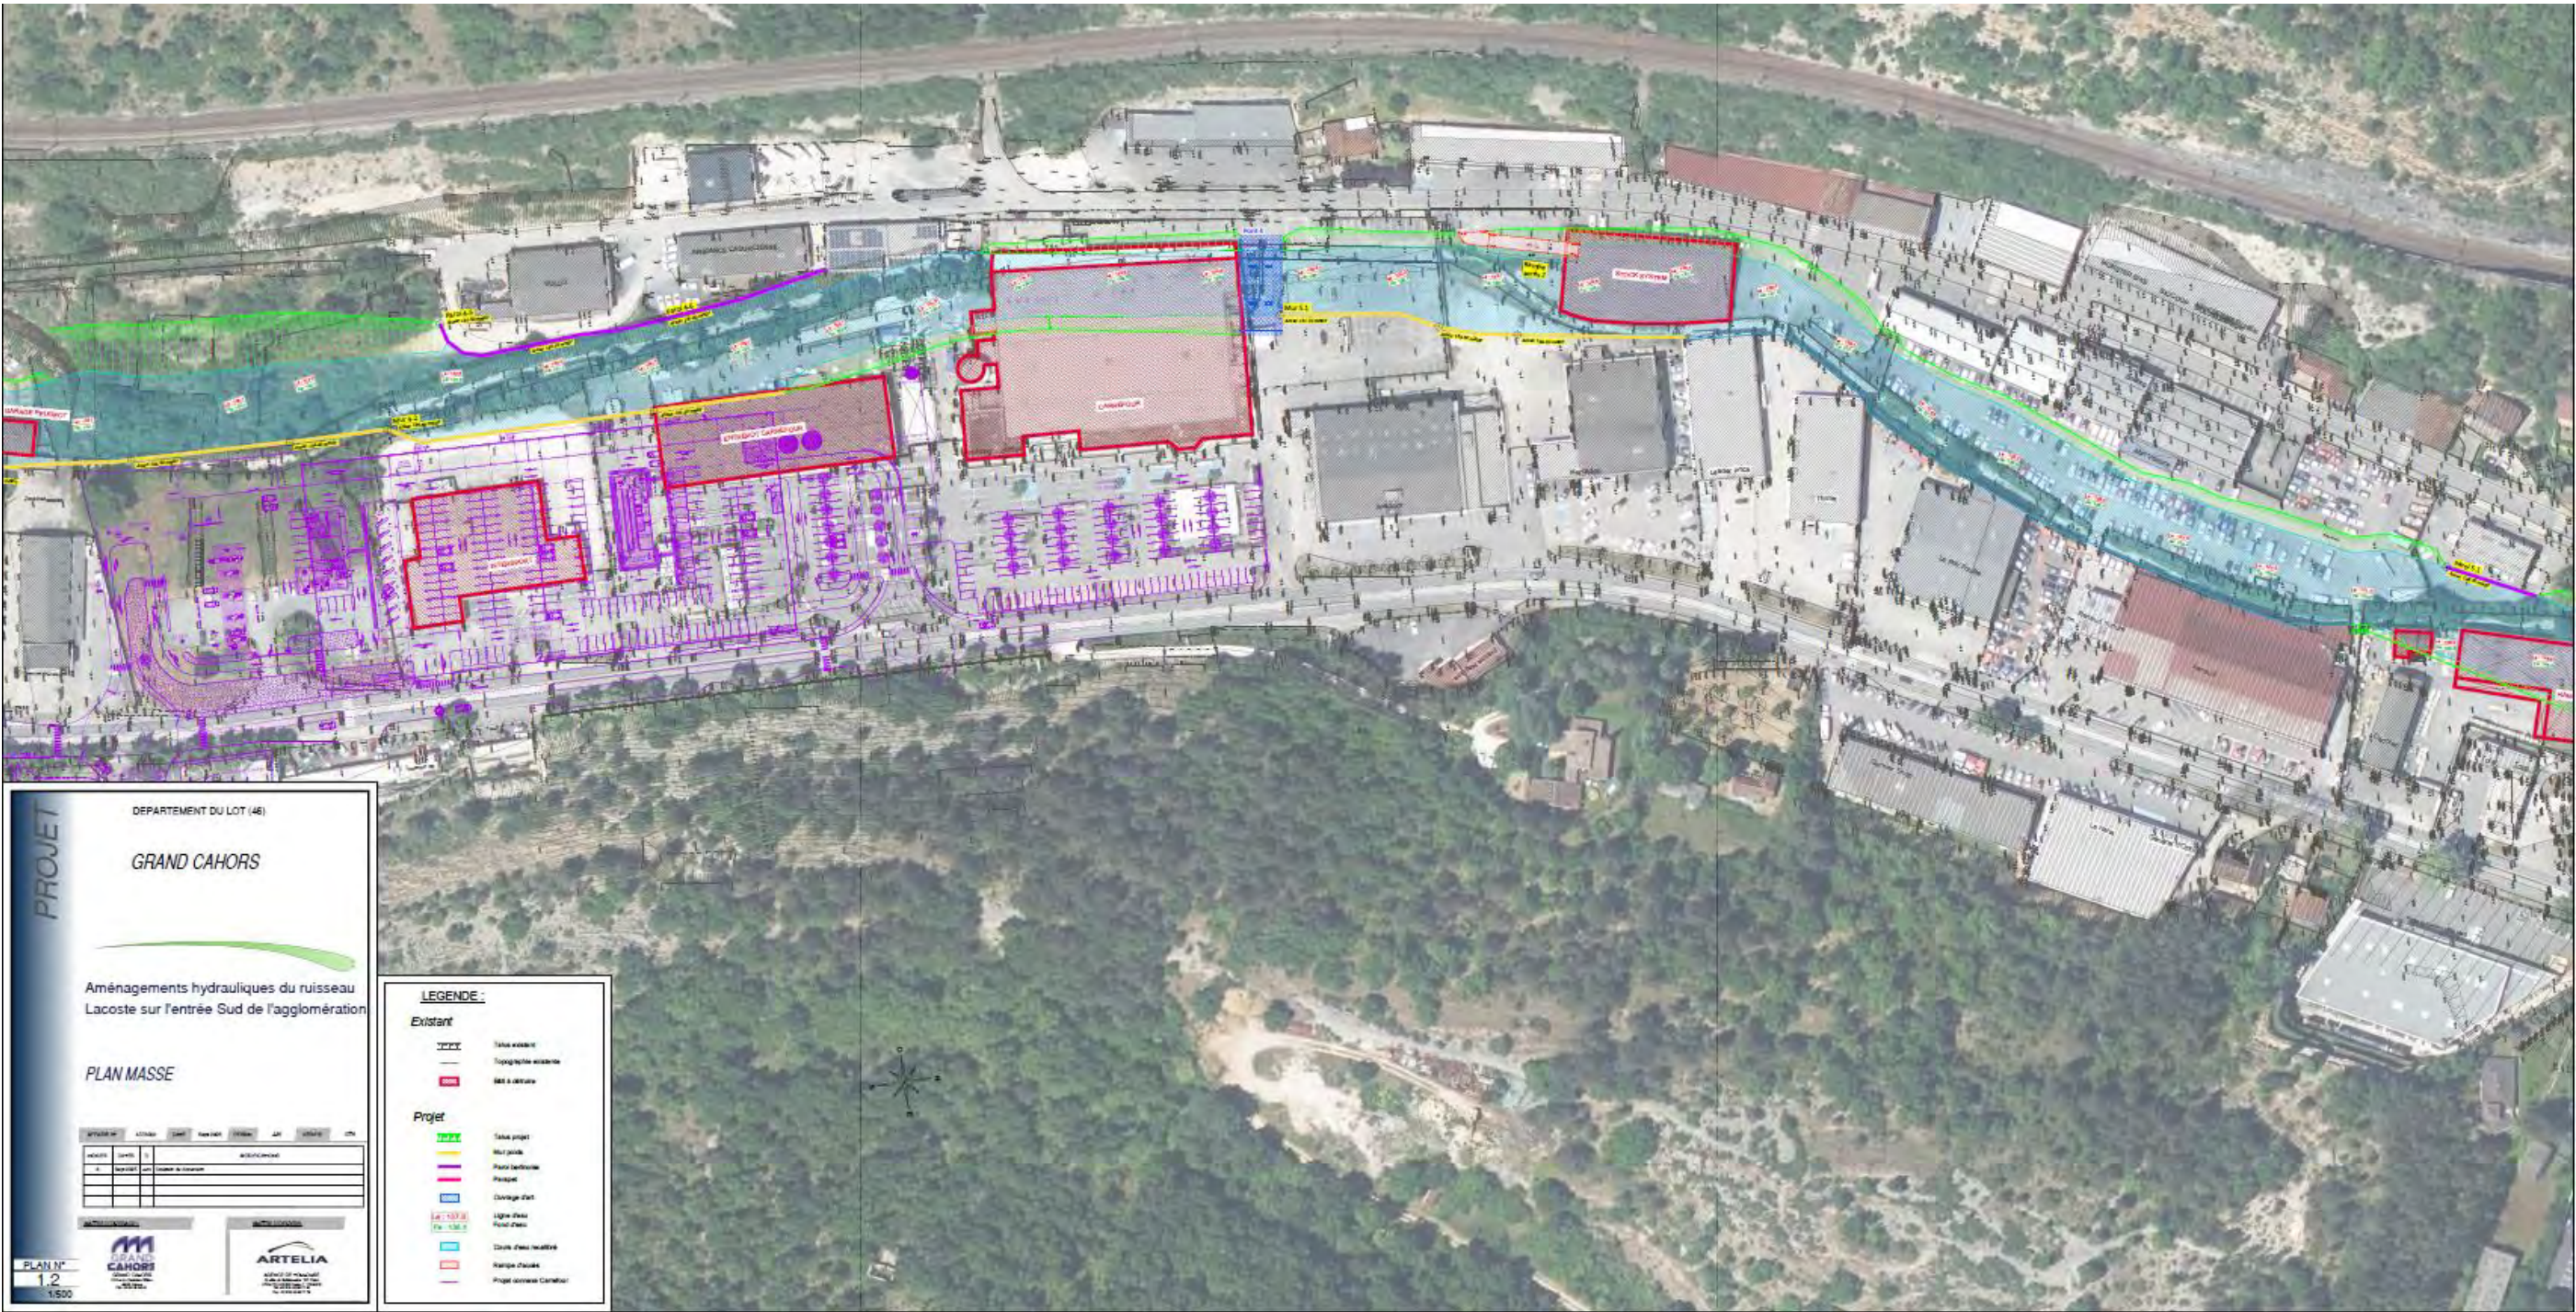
Plan des aménagements projetés – Planche 2 sur 3
